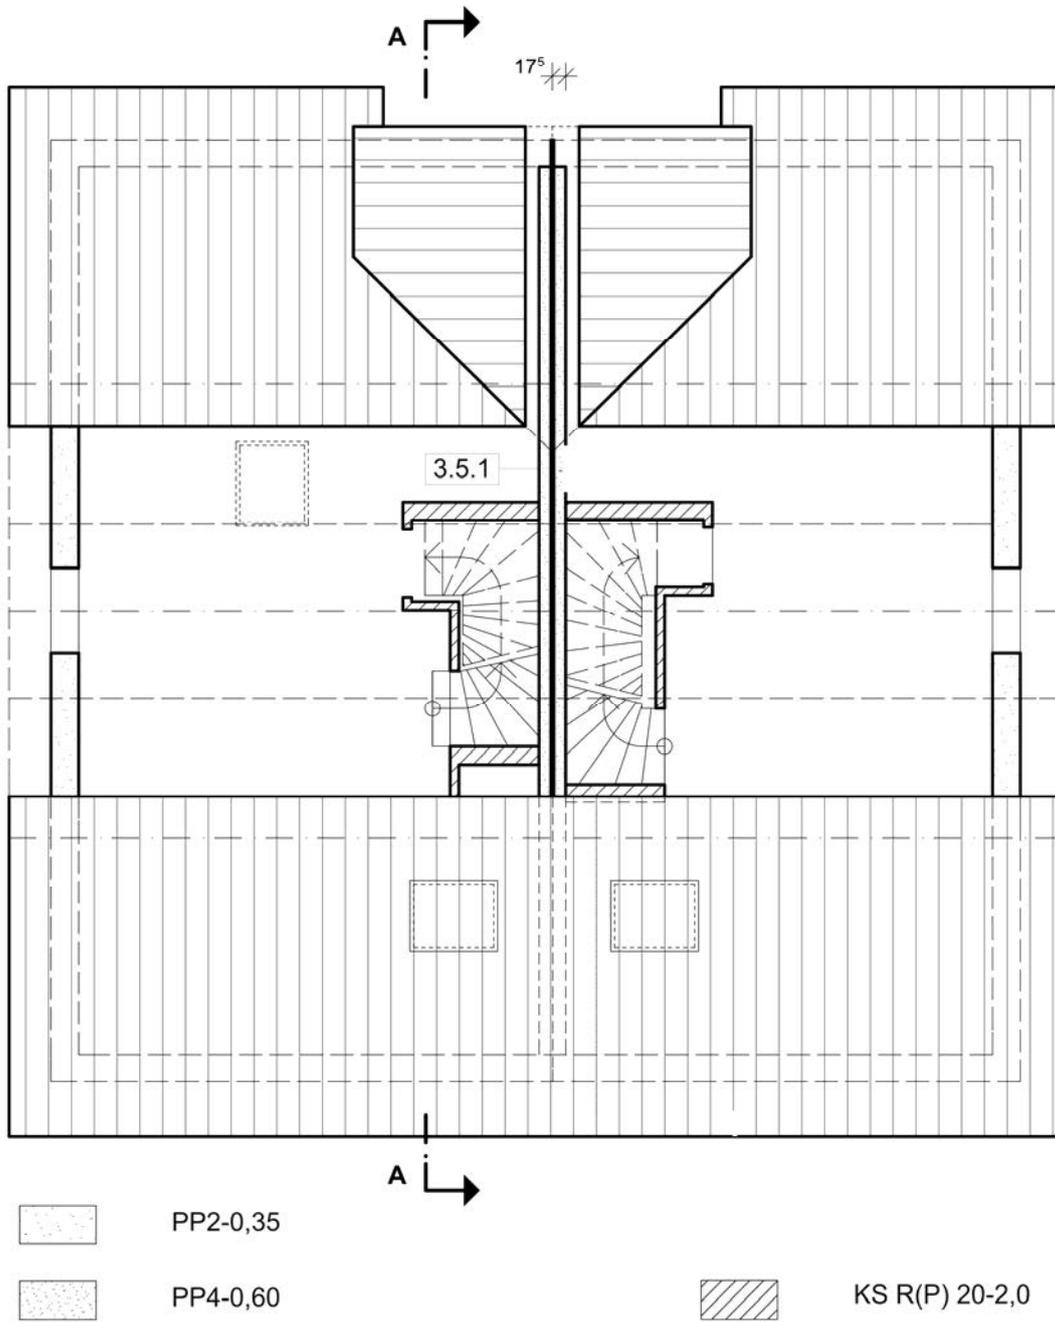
Doppelhaus in Hövelhof, Grundriss Studio
